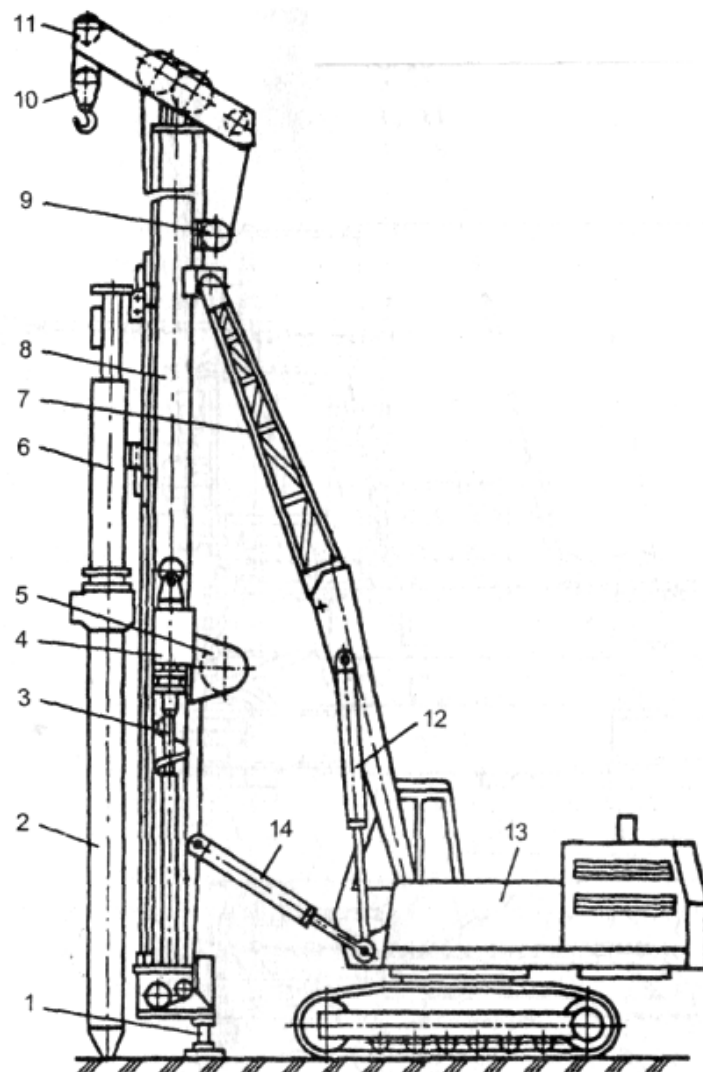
Гидравлический копер: 1 – нижняя опора; 2 – свая; 3 – шнековый бур; 4 – привод; 5 – лебедка; 6 – гидромолот; 7 – решетчатая стрела; 8 – копровая мачта; 9 – грузовая лебедка; 10 – крюковая подвеска; 11 – оголовок; 12 – гидроцилиндры; 13 – гидравлический экскаватор; 14 – гидроцилиндр
